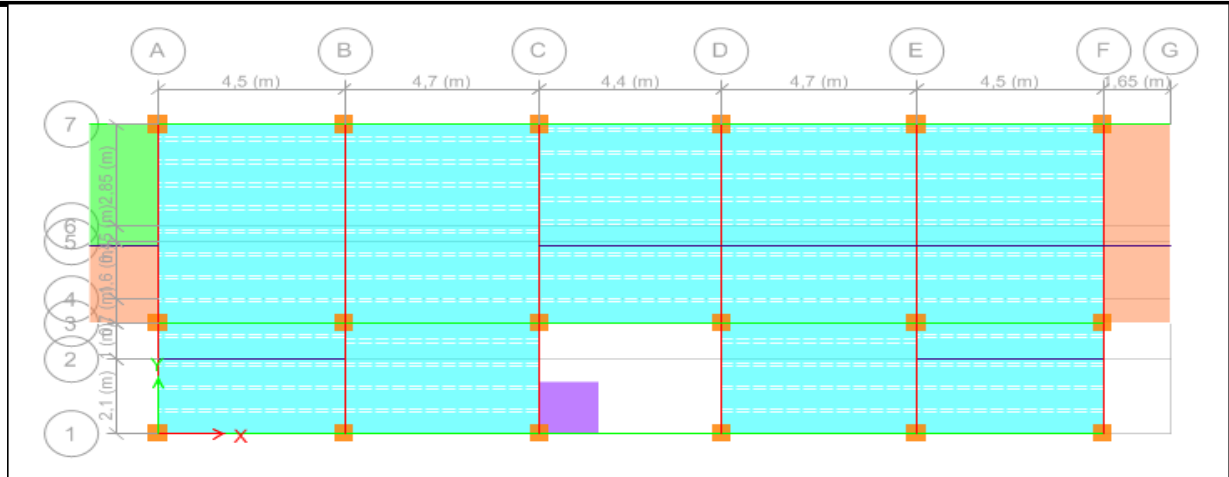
Vue en plan de la disposition des poutrelles de l'étage courant.
